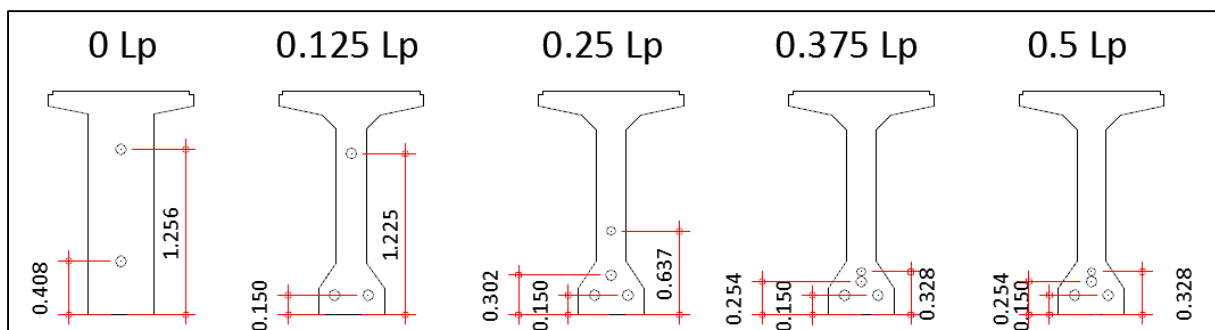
coupes transversales de la poutre type 35m au droit de (0,0.125,0.25,0.375,0.5)Lp
